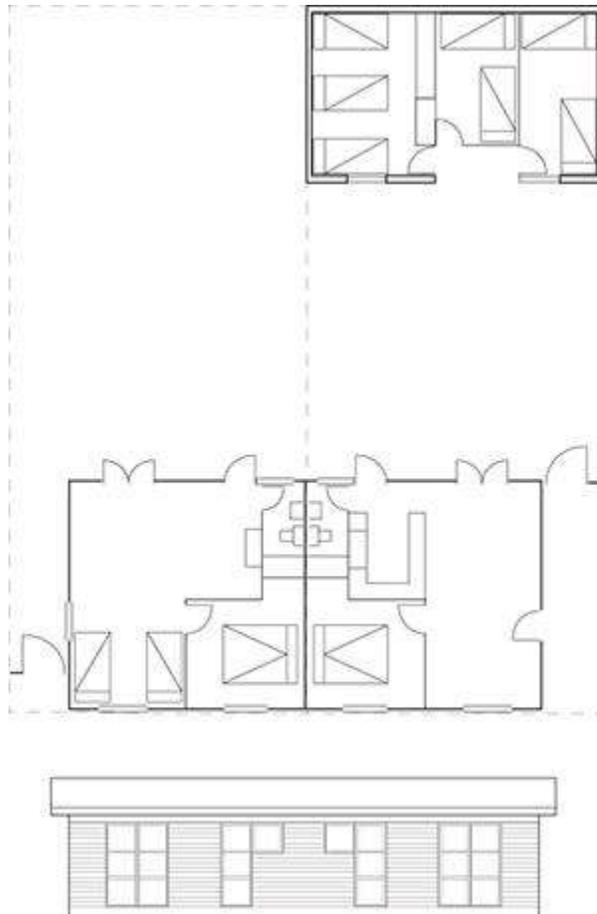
Planta y elevación viviendas de la Villa La Reina. Escala publicada 1: 500. A la izquierda
